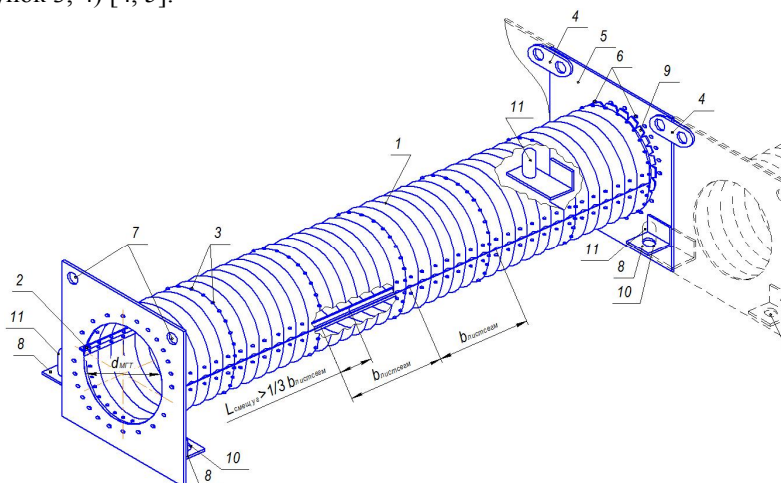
Изометрический вид конструкции из гофрированного металла для водопропуска:
